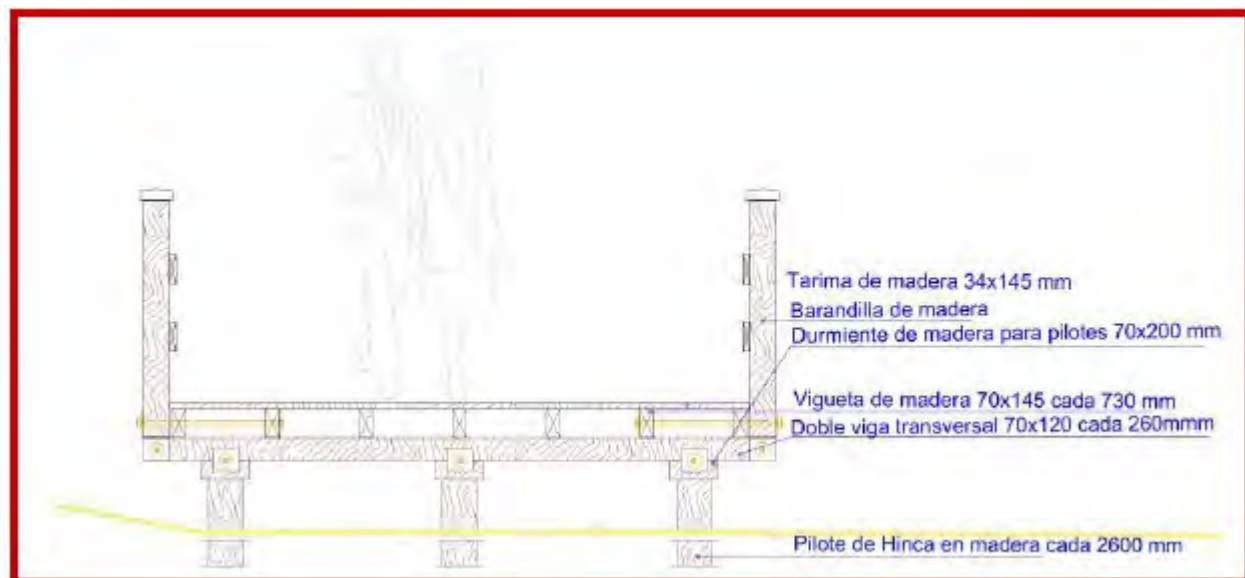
Sección tipo de diseño propuesta en sendero elevado sobre la playa (Fuente: Proyecto básico 2018)
